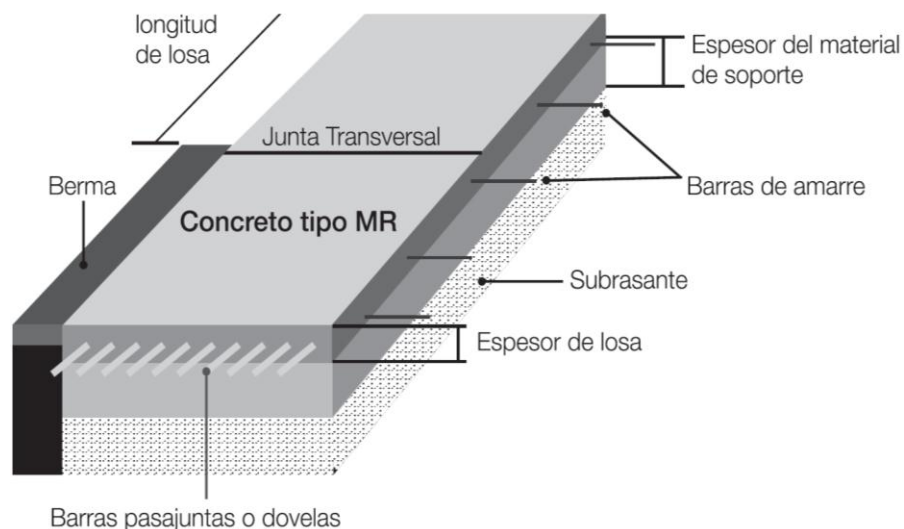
Esquema representativo de un pavimento de concreto
